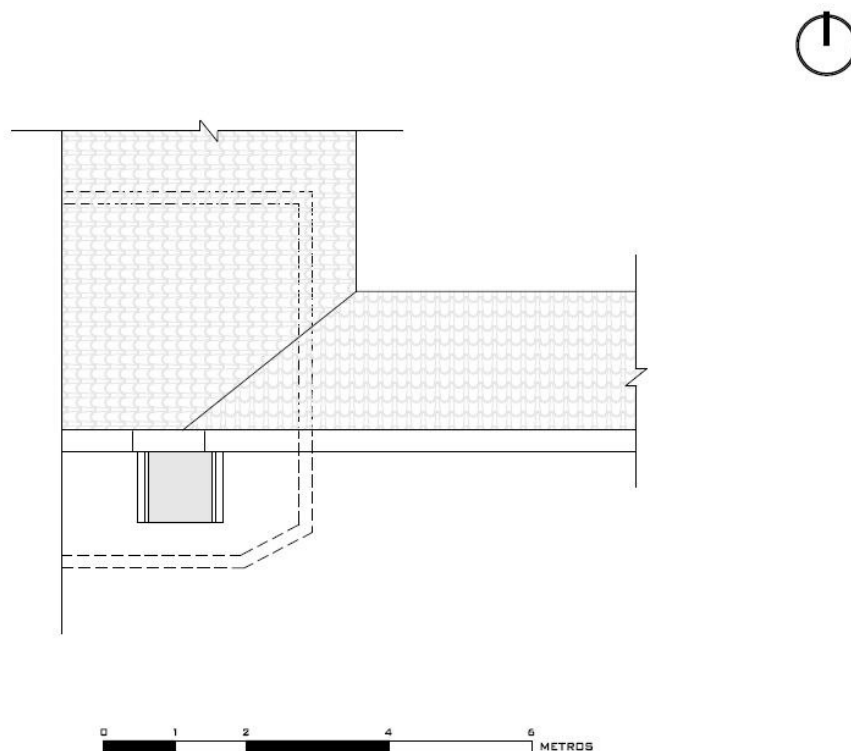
Propuesta - Planta. Elaboración: Autor
